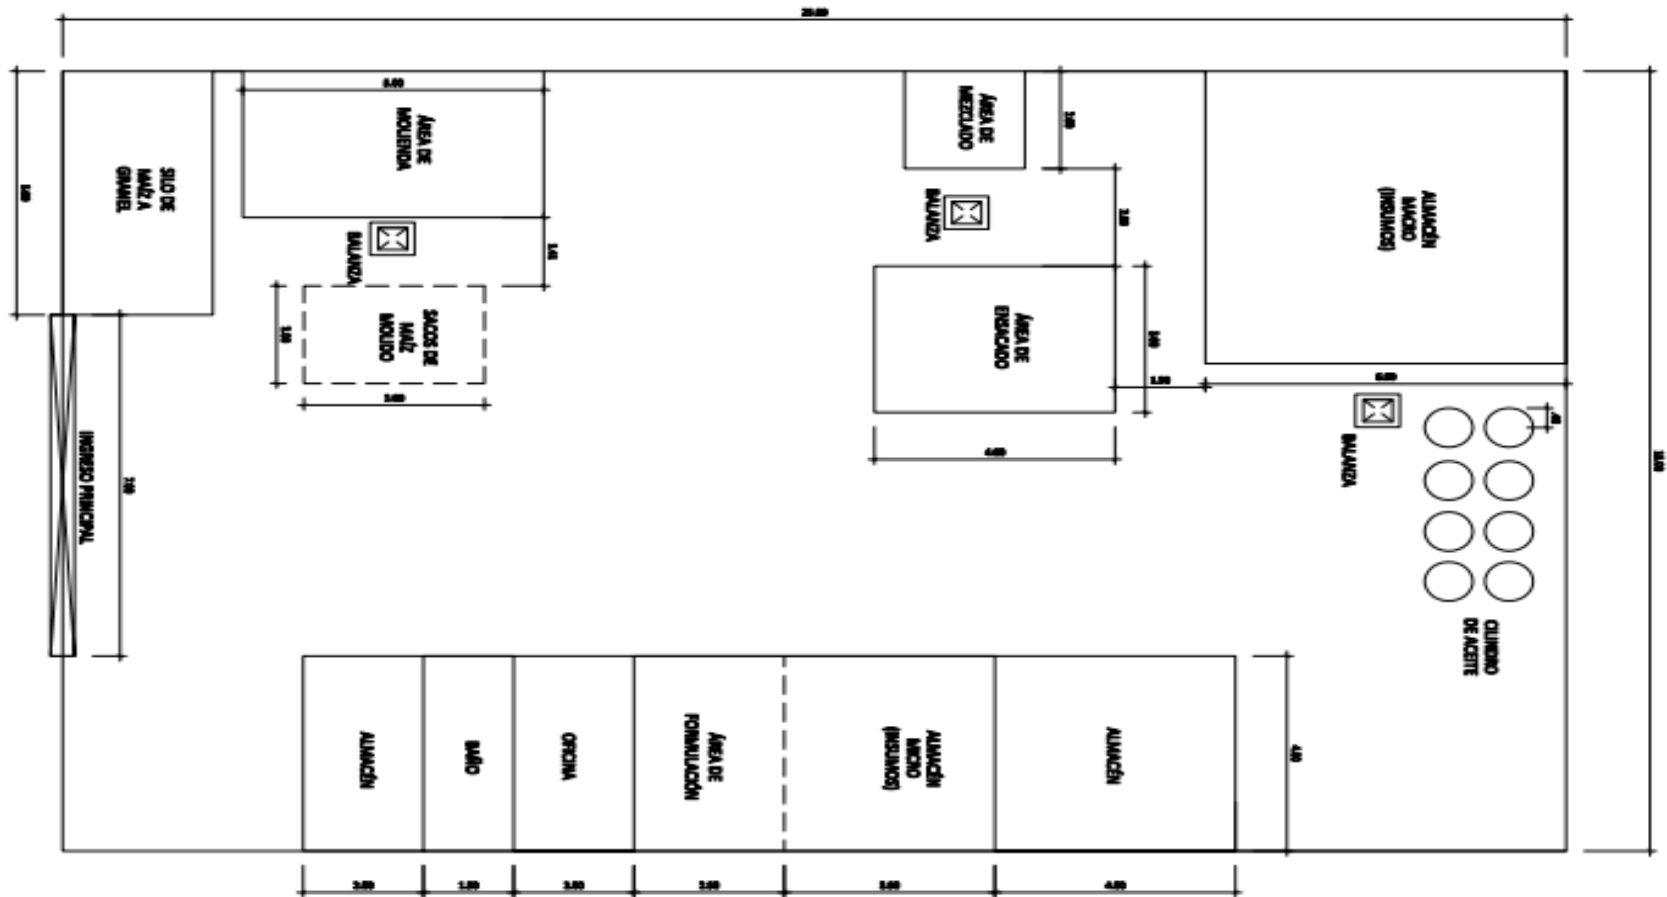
Distribución de planta de la empresa San Bernardo S.A.C
